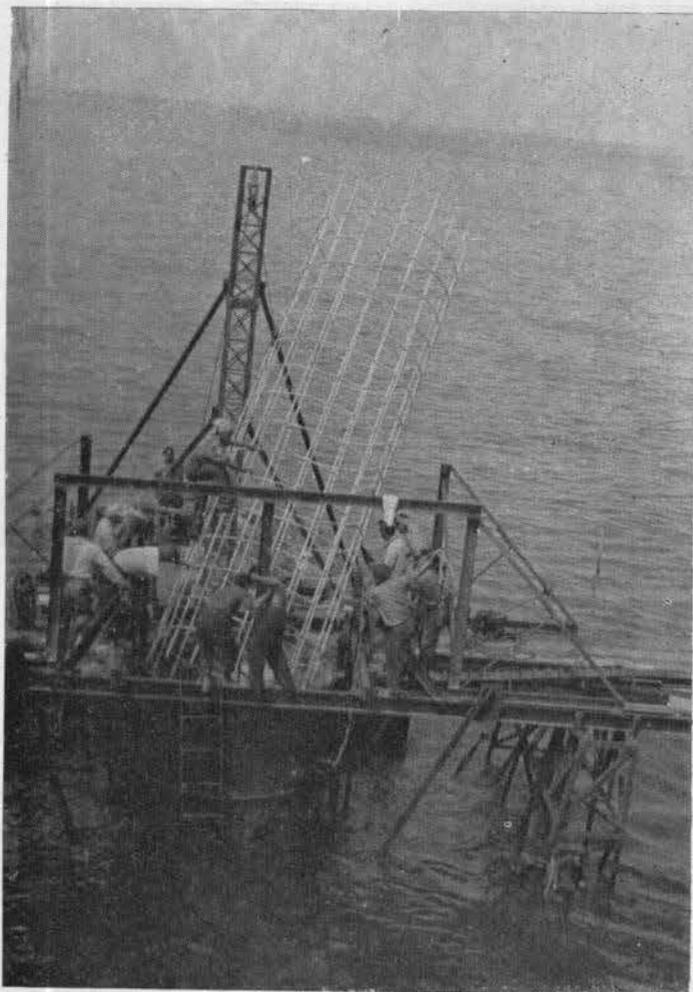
Continuación de la maniobra para introducir el fierro de refuerzo en el molde de la pila.
